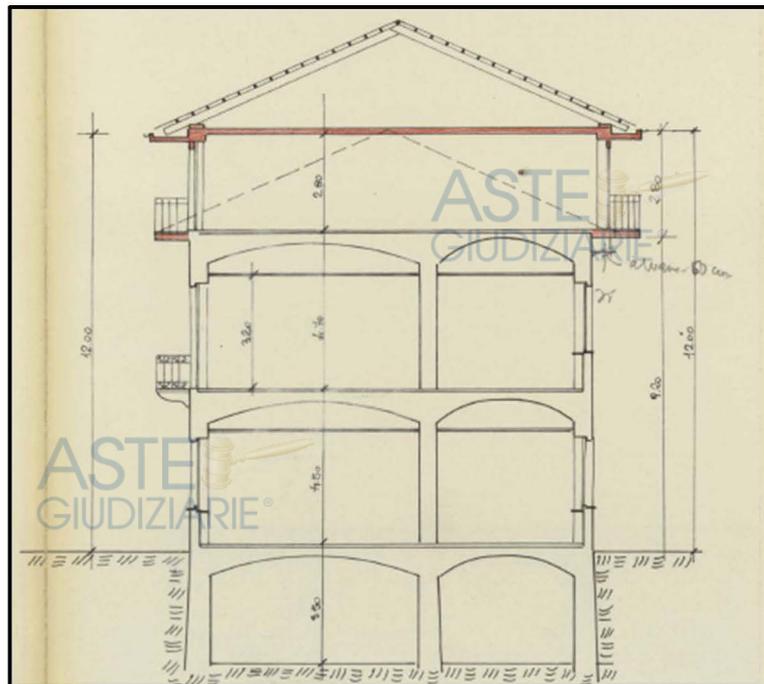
Estratto sezione progetto Licenza edilizia prot. n. prot. 1968 1 30281
